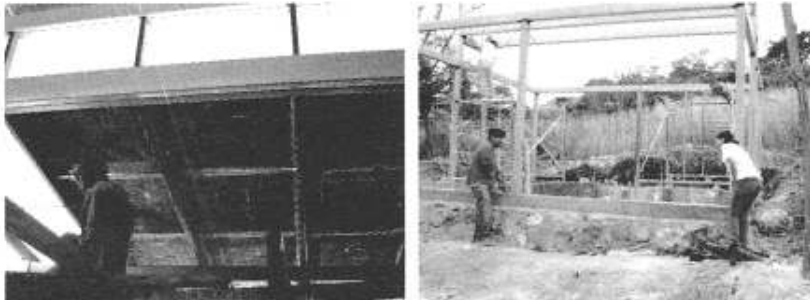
Colocación de la estructura metálica utilizada como elemento guía para la autoconstrucción de techos y paredes, siendo primero el techo, para permitir trabajar el mayor tiempo posible bajo sombra.
